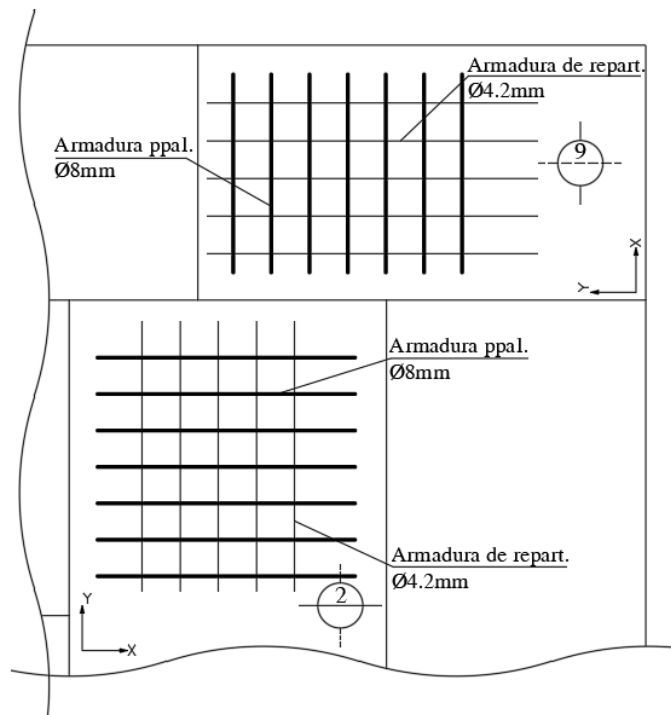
Esquema de posición de armaduras según planilla para Losas L2 y L9.
